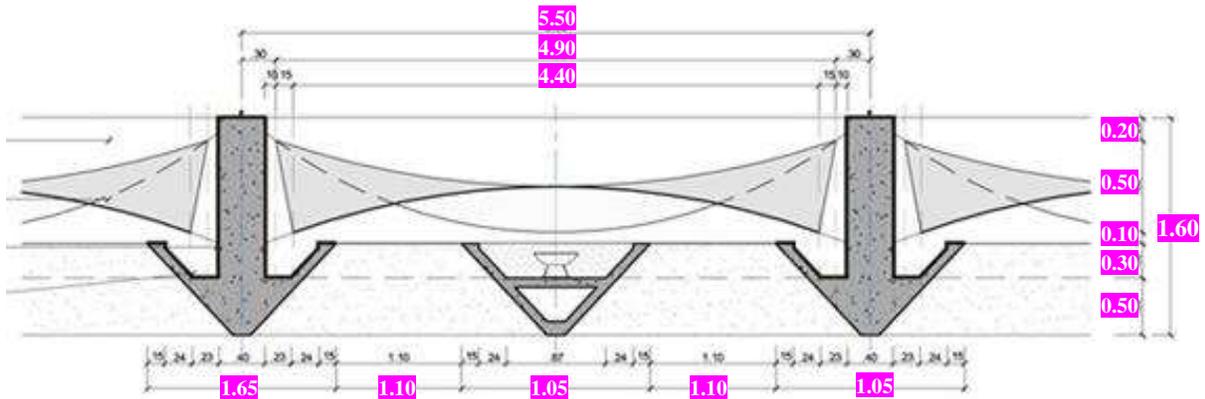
Vigas en “V”. (Raurell, 2010)
